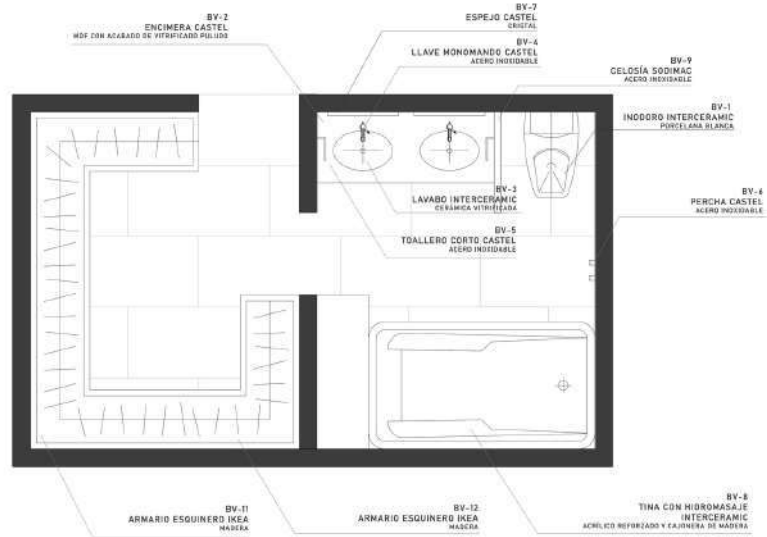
Planta de baño mobiliario. Fuente: Autoría propia.
